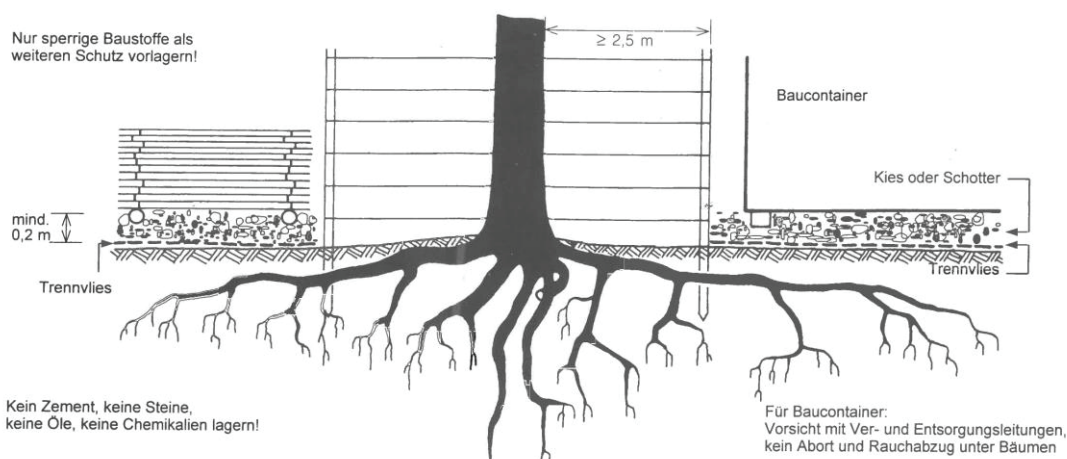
Schadensbegrenzung bei zwingend notwendigem Befahren des Wurzelbereiches und sonstiger befristeter Belastung
